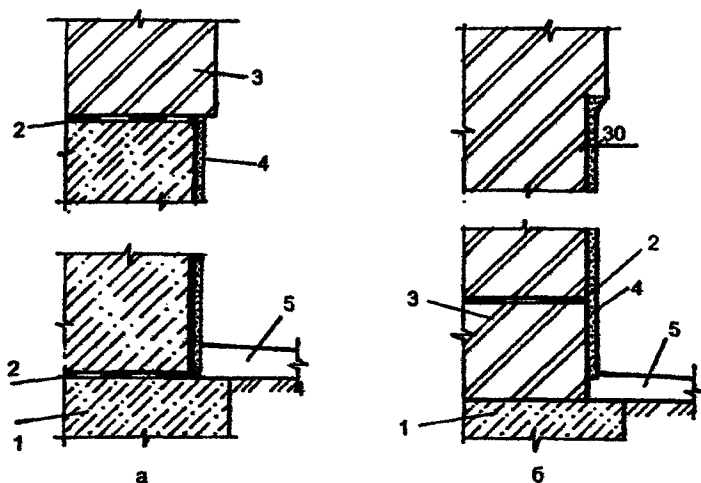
Цоколи стен из кирпича и бетонных блоков:
